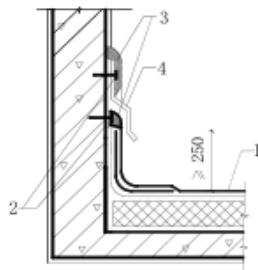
混凝土墙体泛水卷材张口、脱落渗漏维修
